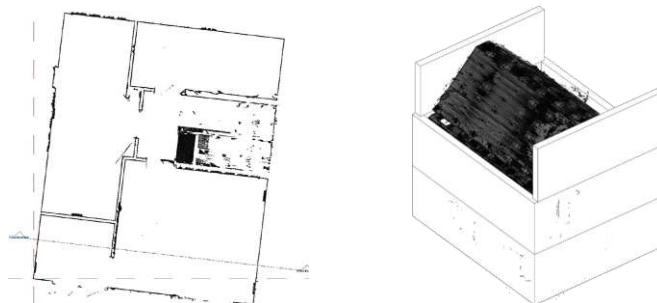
Grundrissansicht der importierten Punktwolke (links) und die fertig angepassten Außenwände aller Geschosse (rechts)
